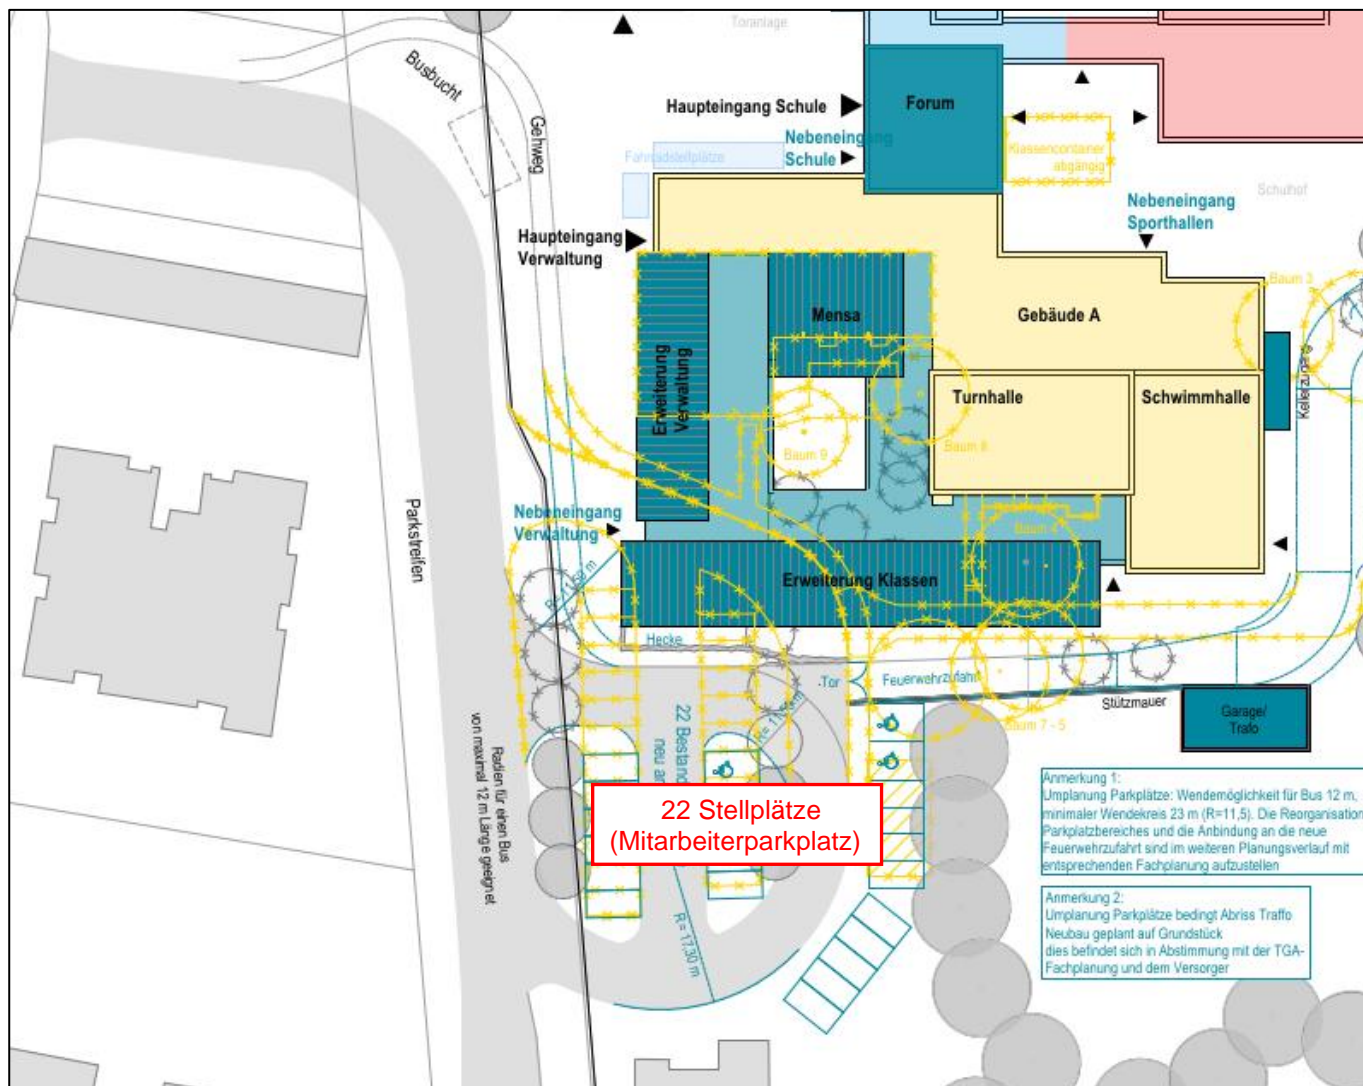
Parkplatz Schule – Ausschnitt aus Lageplan des Büros Lindner Lohse Architekten mit Lage der Stellplätze
